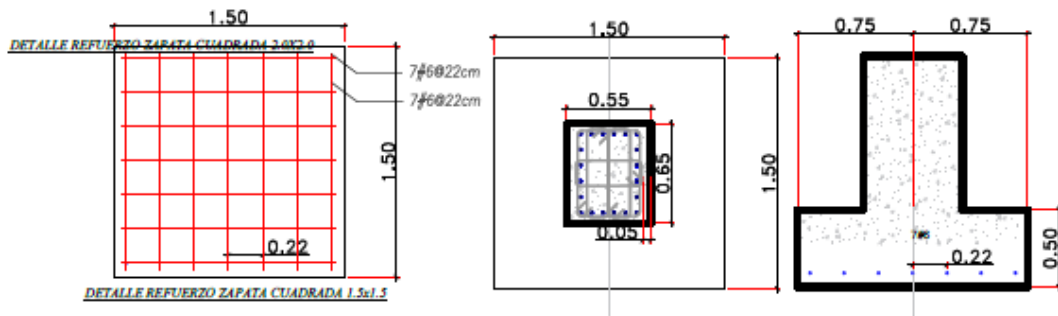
Zapata cuadrada 1.5X1.5 metros
